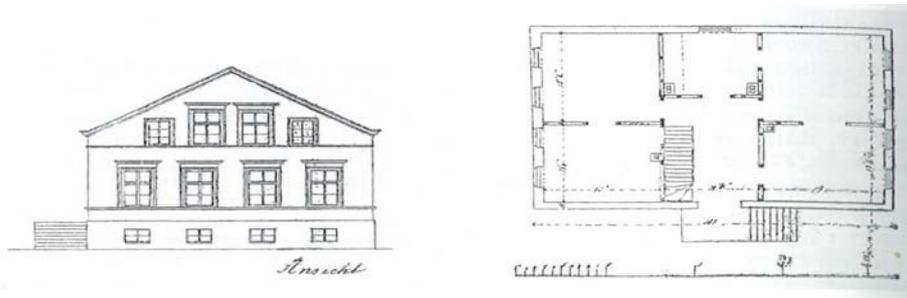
Grundriss und Ansicht eines Arbeiterwohnhauses
